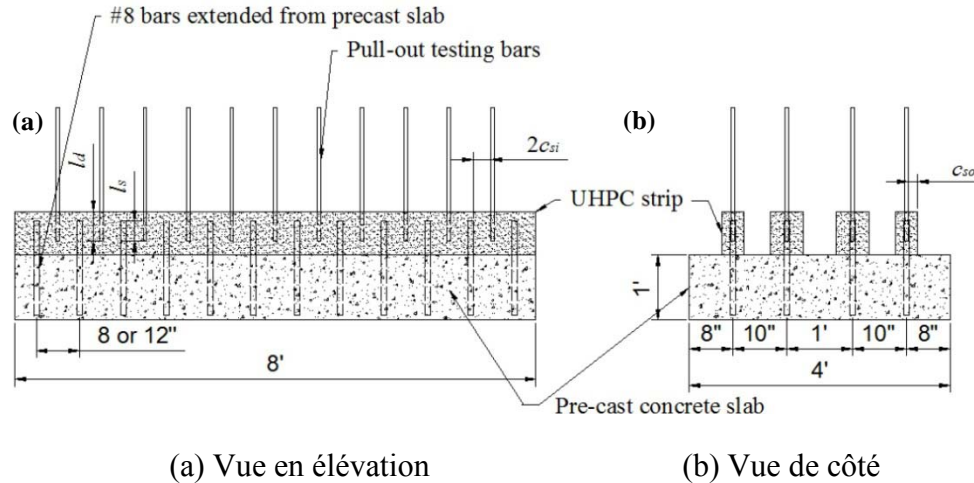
Illustration de l'essai d'arrachement avec barres chevauchées (Yuan et al. 2014)
